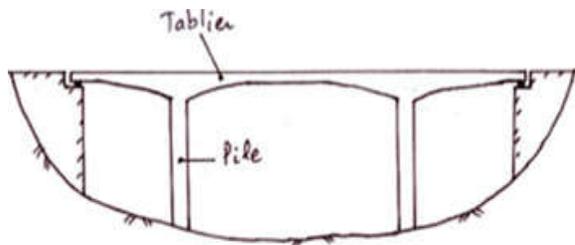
Pont portique ouvert, ou pont à béquilles verticales
